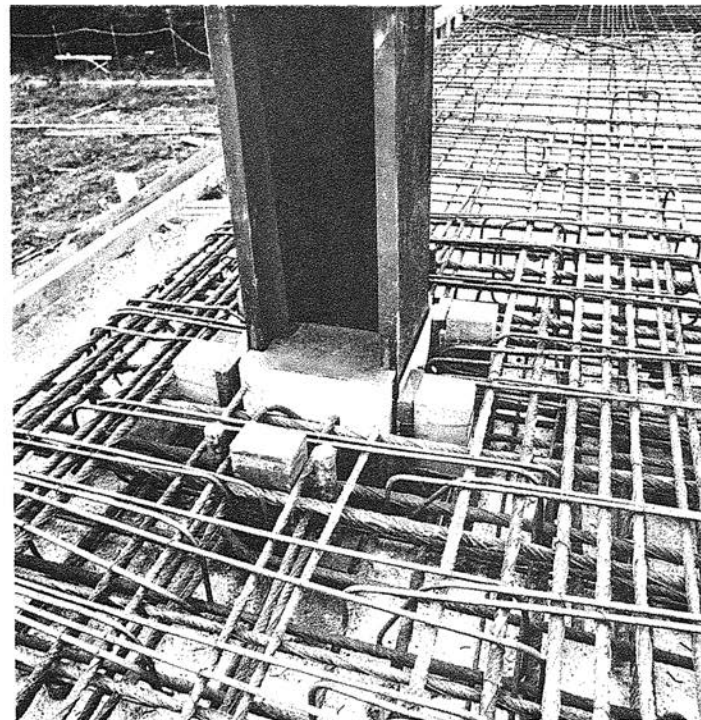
Bewehrung der Hubdecke im Bereich einer Stahlstütze
